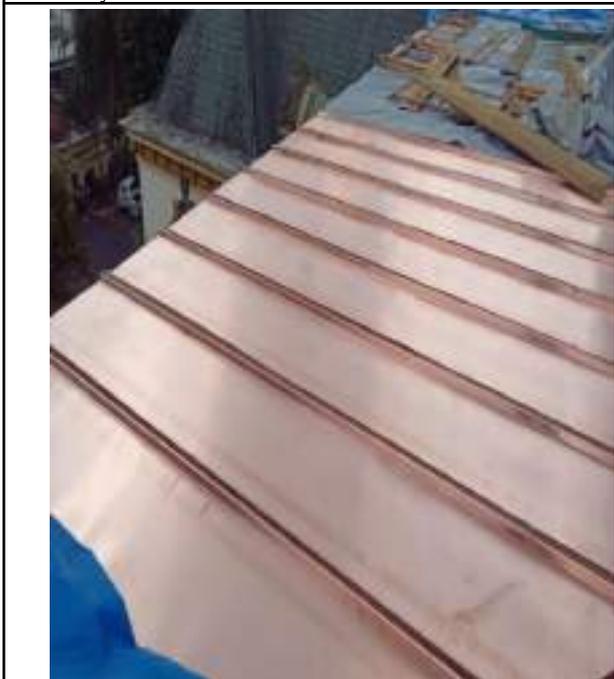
Atividade de conservação da cobertura, instalação das telhas em cobre.
